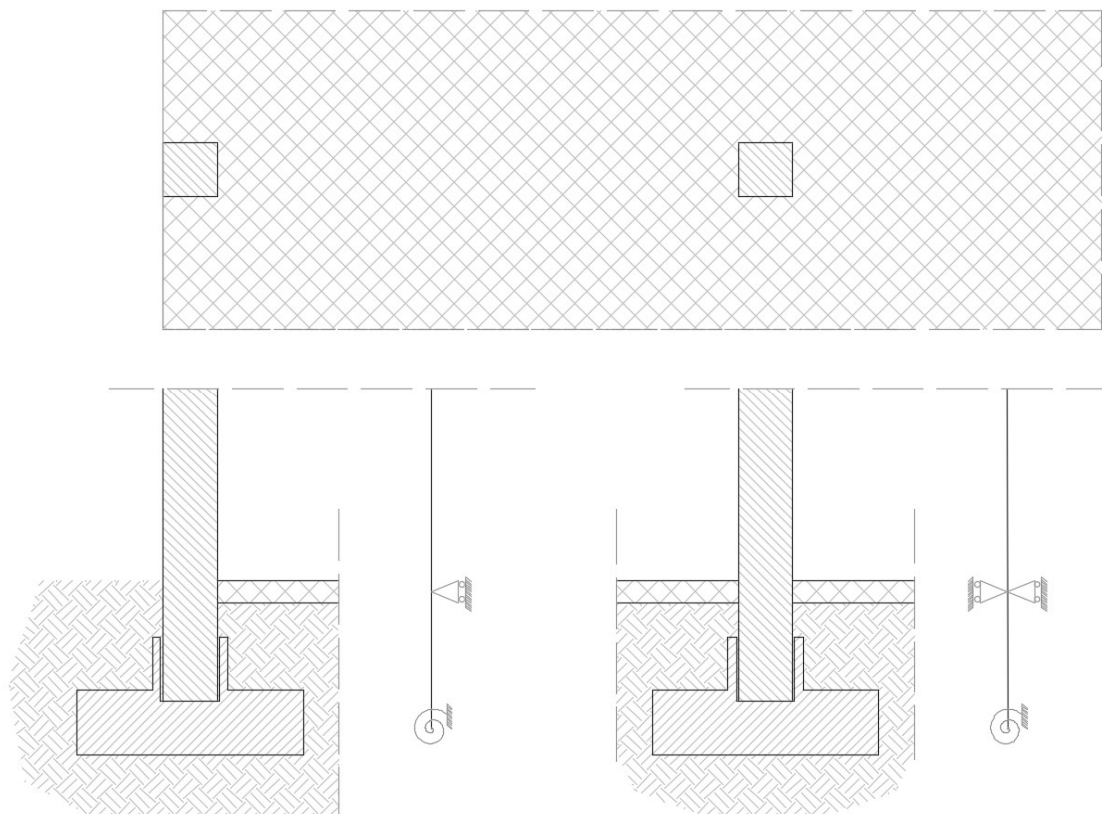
Schema relativo al vincolo d'incastro nelle differenti condizioni di pilastro centrale e pilastro d'angolo
